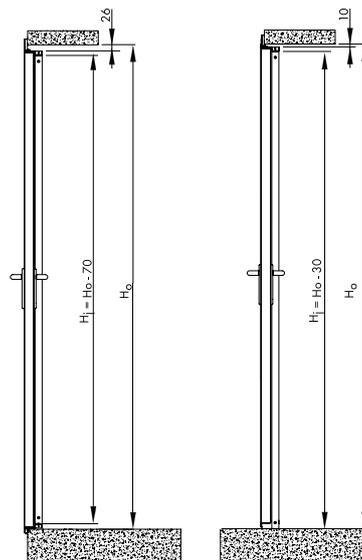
Montage einflügeliger Türen mit Schwelle - Vertikalschnitt.
